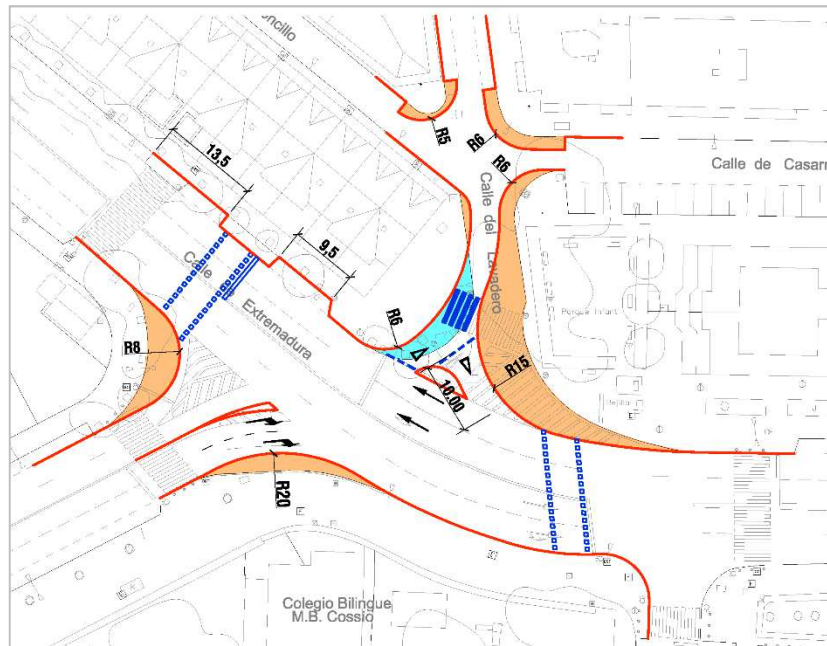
Propuesta actuación en la intersección de las calles Extremadura, Lavadero y Comunidad de Madrid.
